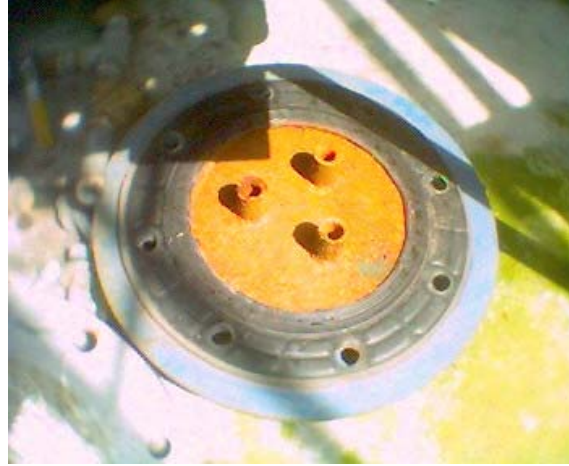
Tapa del bajo dren o falso fondo con tres boquillas para alimentación.
